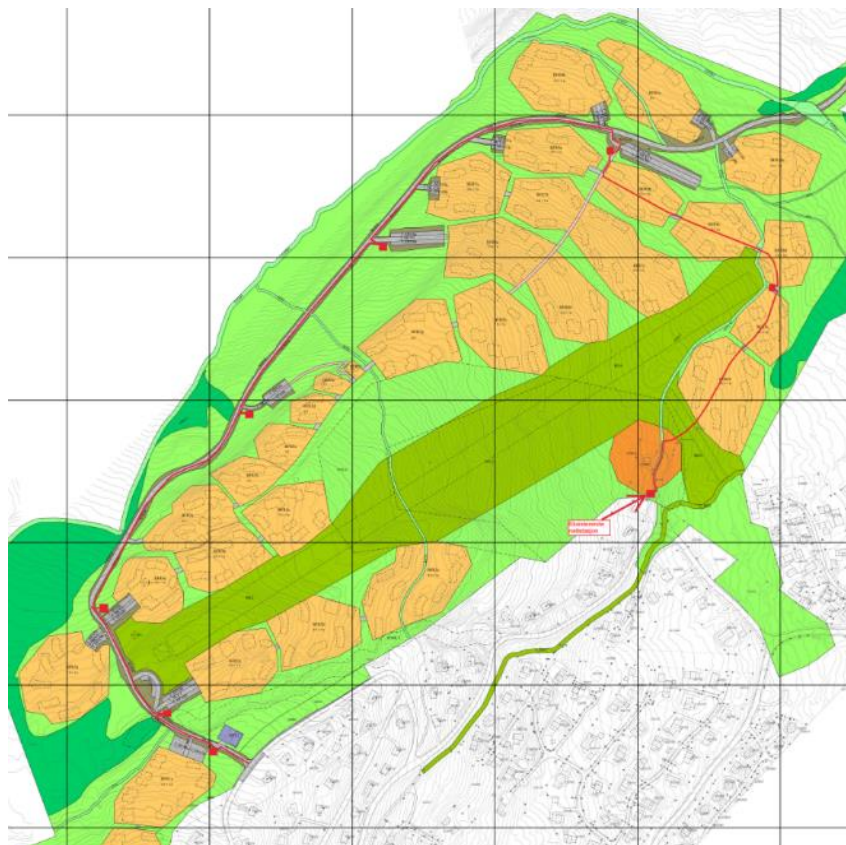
Avrenningsmønster i planområdet, fra VA-rammeplan
